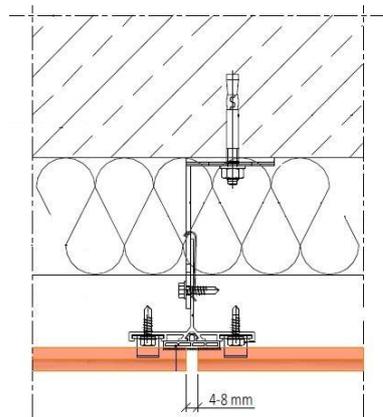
Sección horizontal. FAVEKER® FV. Sistema clip.
